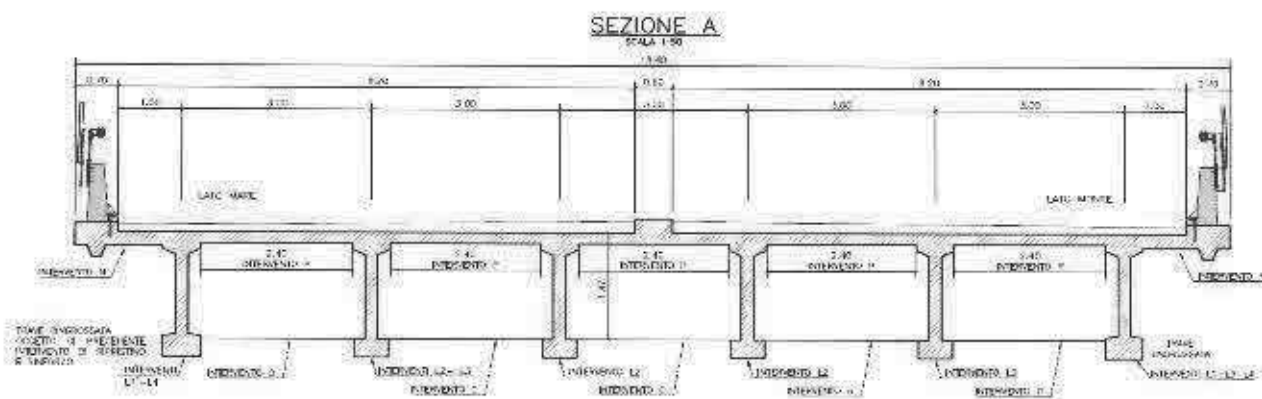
sezione trasversale dell'impalcato tampone appoggiato alle pile
